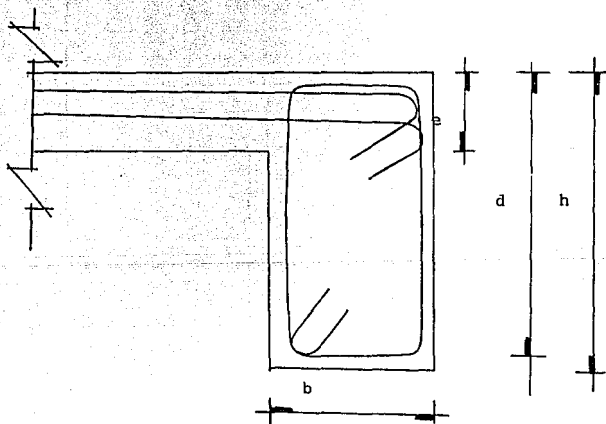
ARMADO TÍPICO DE UNA SECCIÓN DE LOSA DE CIMENTACION EN CONJUNTO CON UNA CONTRATRABE PERIMETRAL.
